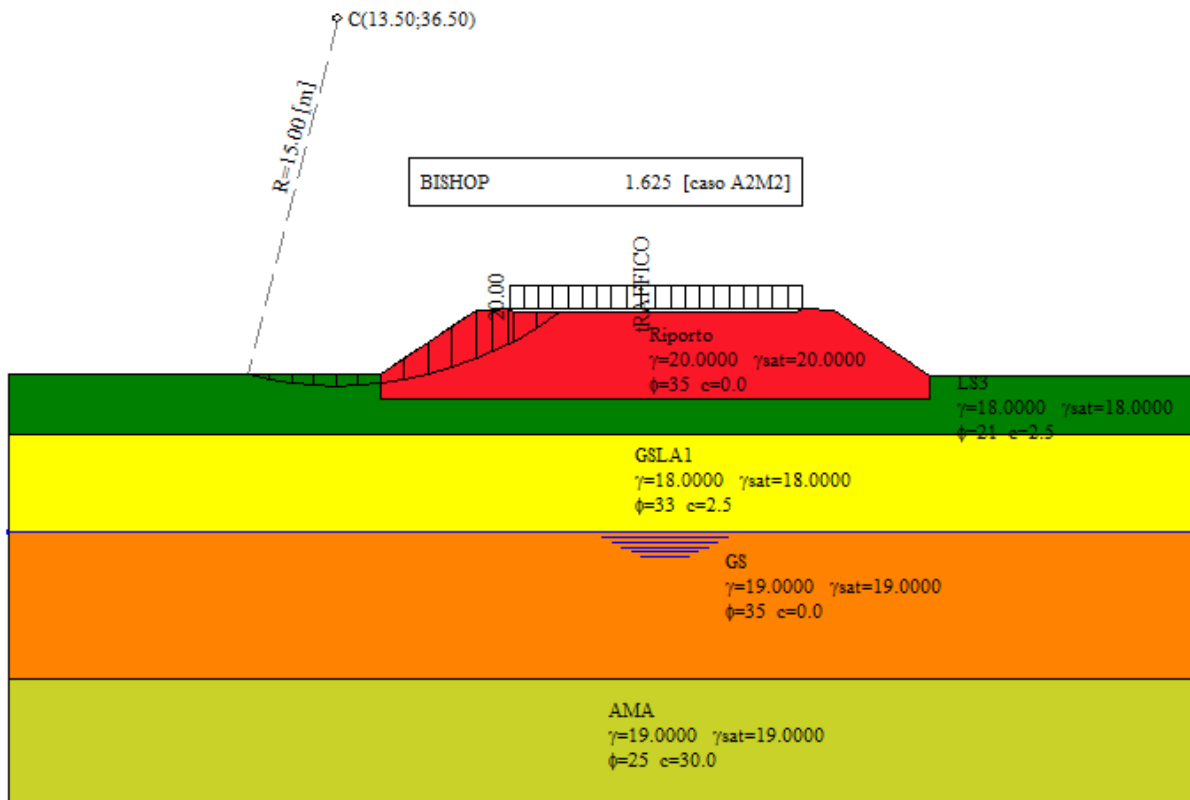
Verifica di stabilità globale - condizione statica drenata
